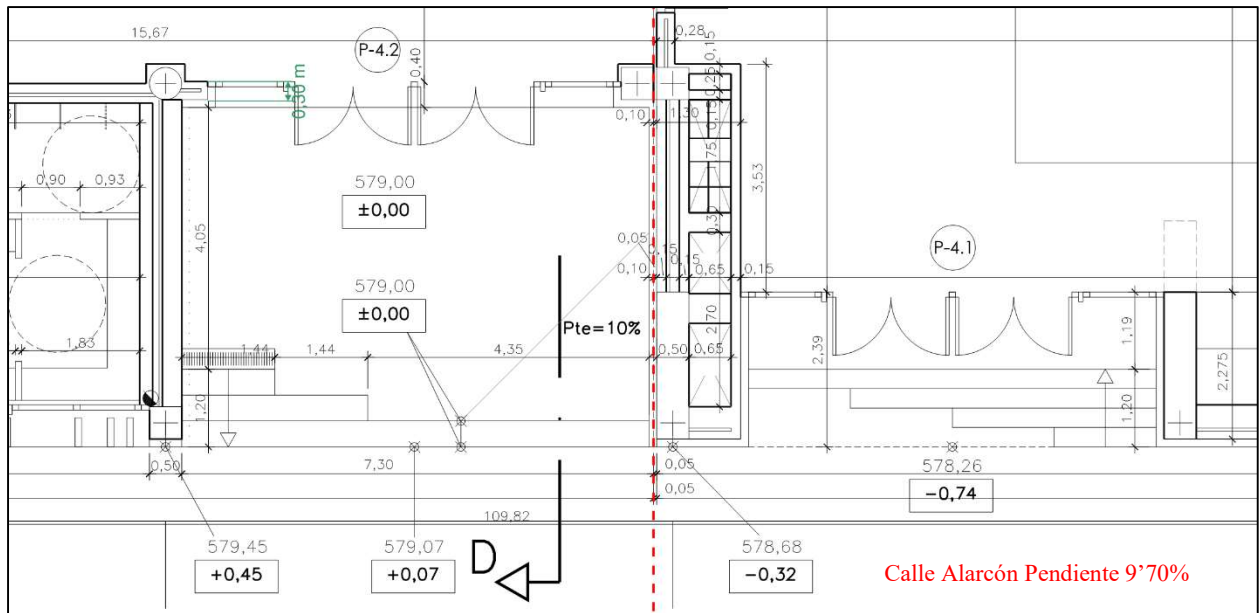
Accesos al edificio desde la Calle Alarcón. Plano de replanteo.
